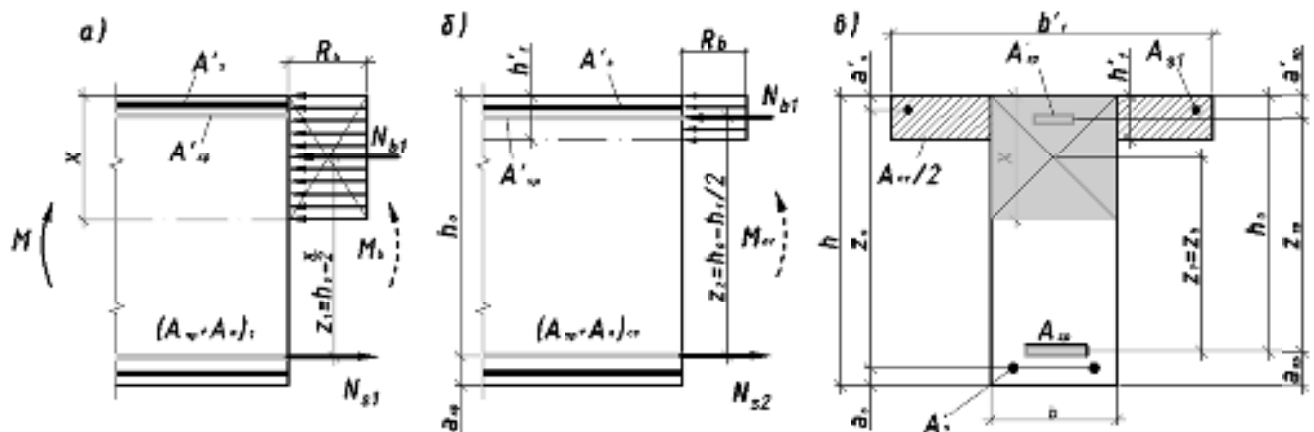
Схема усилий и напряжений в нормальном расчетном сечении таврового профиля с двойной арматурой
